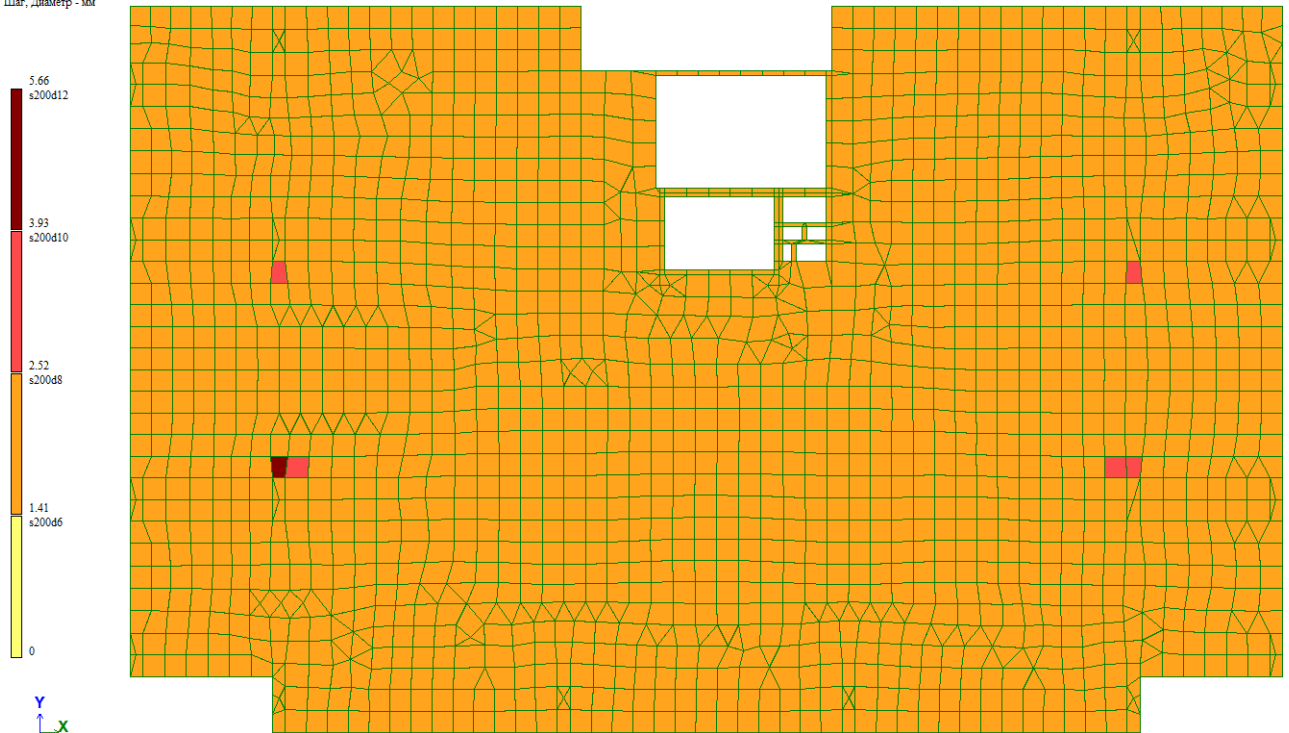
Верхнє армування плити першого поверху вздовж осі Y
